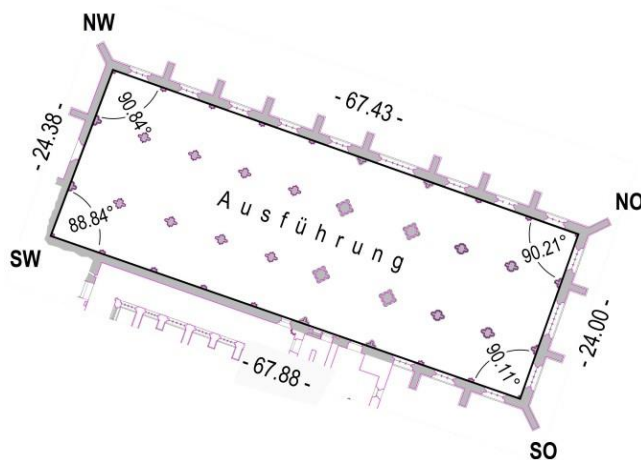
Münster Neuberg, das Grundrechteck (inneres Rechteck) der Planung wird durch die Ausführung zu einem beliebigen Viereck, dessen Geometrie aus Plan Abb.6 (oben) mittels CAD im metrischen System graphisch erfasst wurden.
